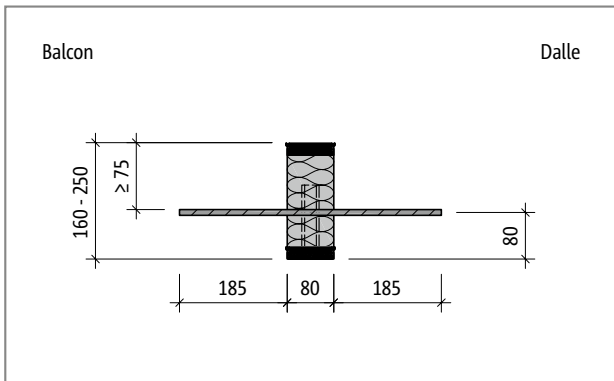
Schöck Isokorb® T Type H-NN1 : Coupe du produit
